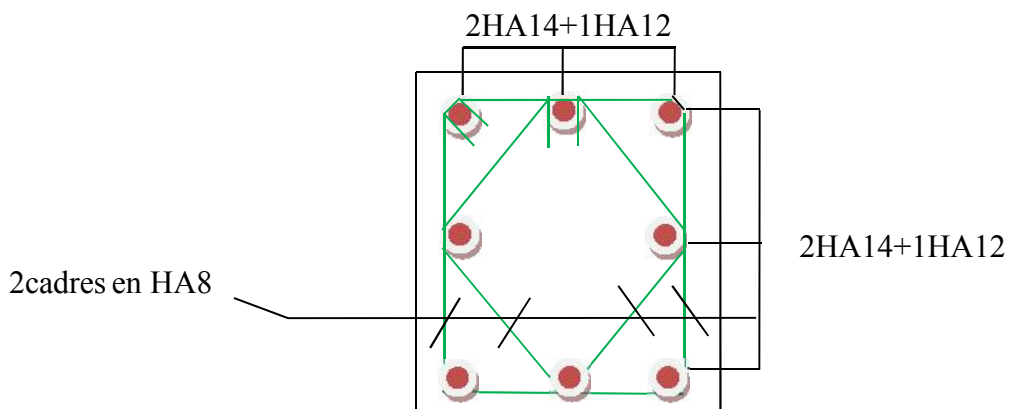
Coupe verticale sur poteau (35x35)cm²
